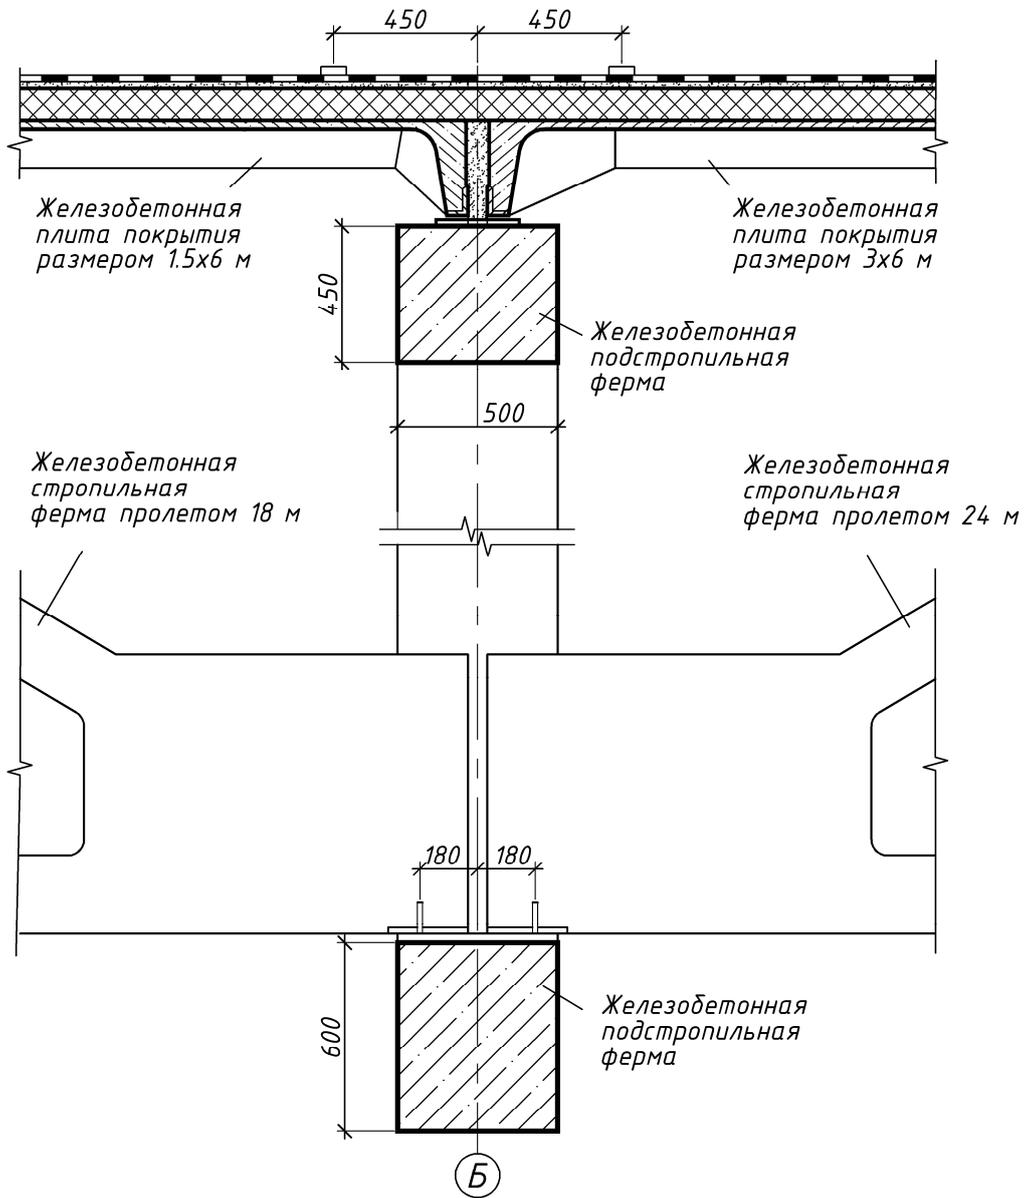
Узел опирания стропильной фермы на подстропильную
